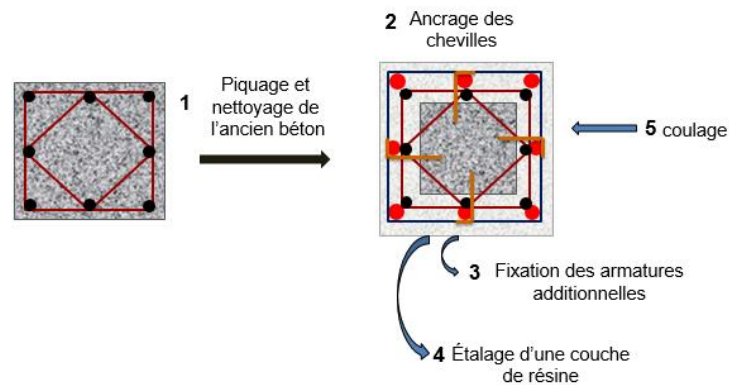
Chemisage par Augmentation des sections des poteaux.
